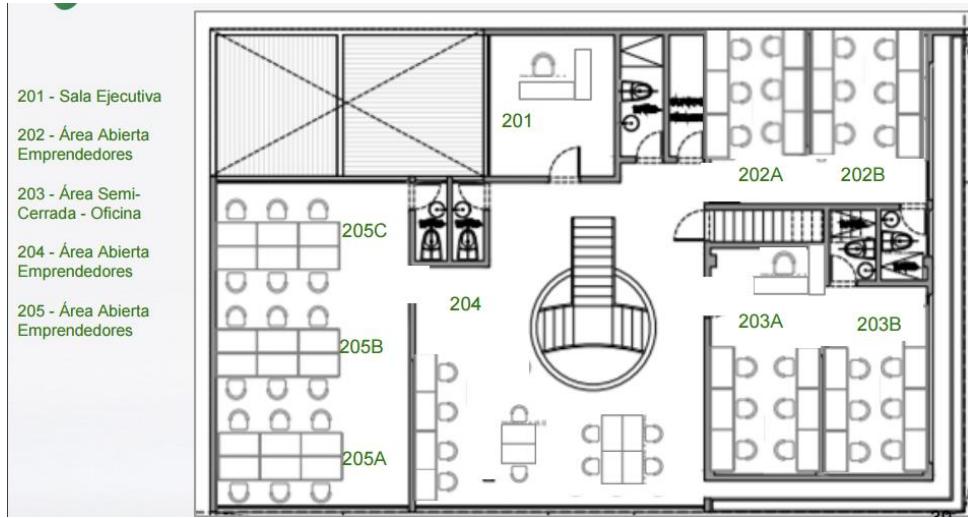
Plano de distribución segunda planta. Fuente: (51)
